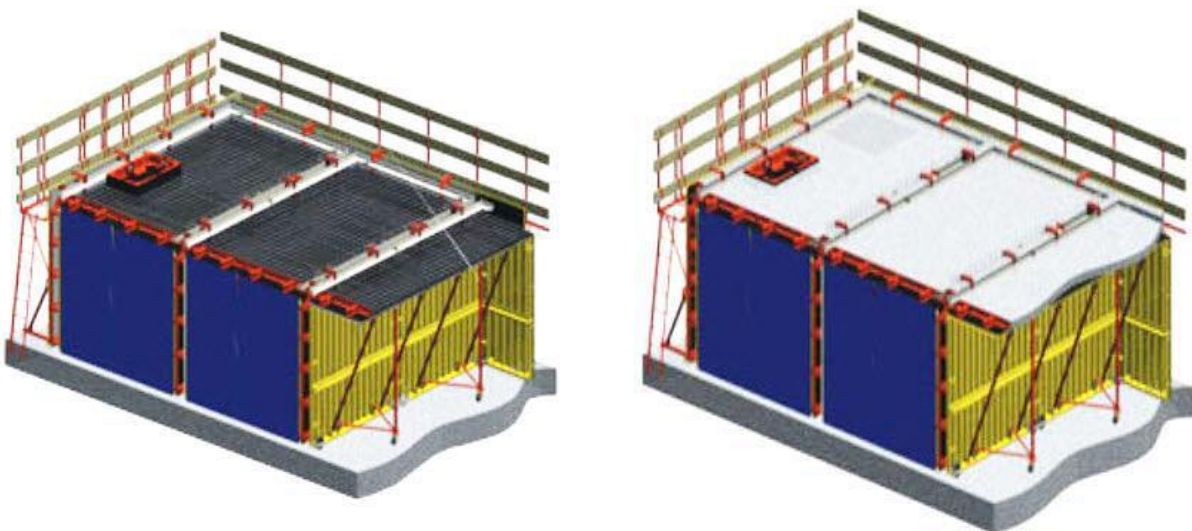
Mise en place des banches pignon et Mise en place du ferrailage des dalles.
